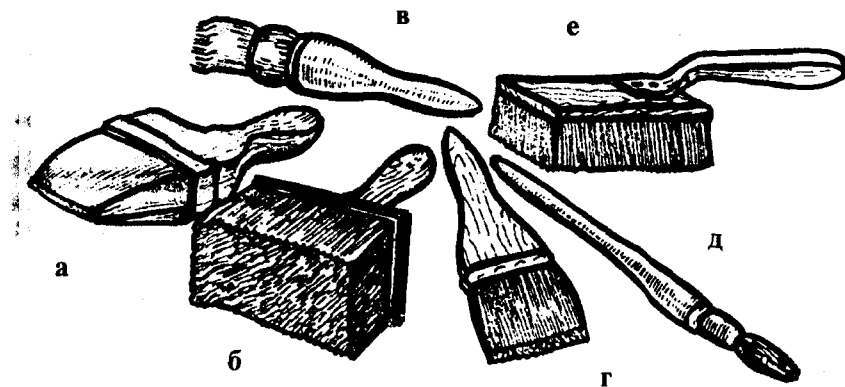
Кисти: а — побелочная; б — макловица; в — ручник; г — флейц; д — филиночная; е — торцовка
